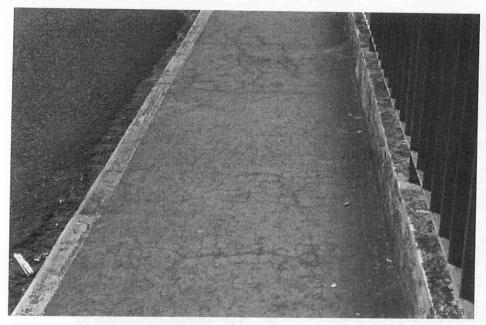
Detalhe das fissuras no passeio estão por toda a sua extensão.
